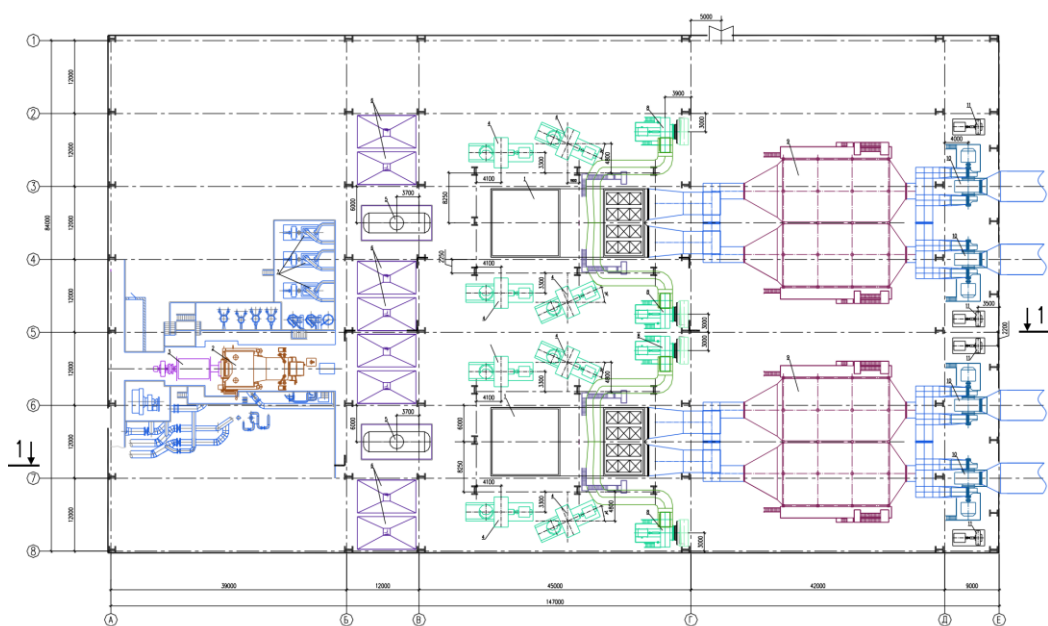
План главного корпуса типовой ТЭЦ [34]
